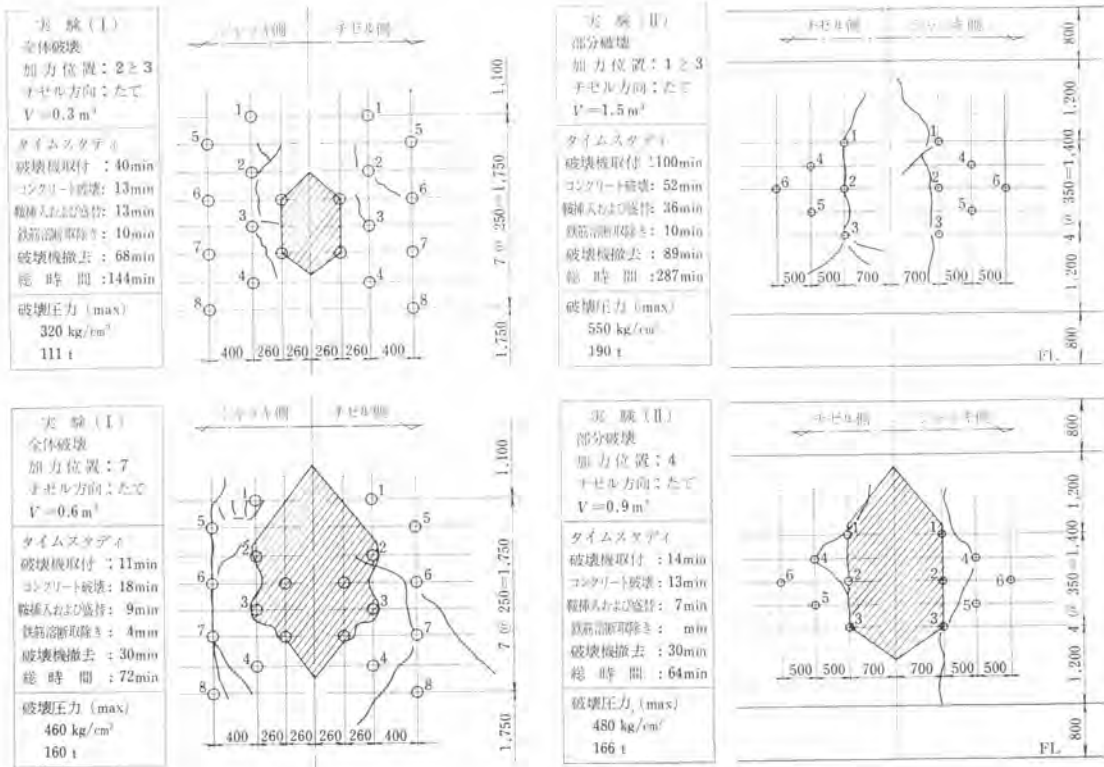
引込式コンクリート破壊機試験亀裂状況
